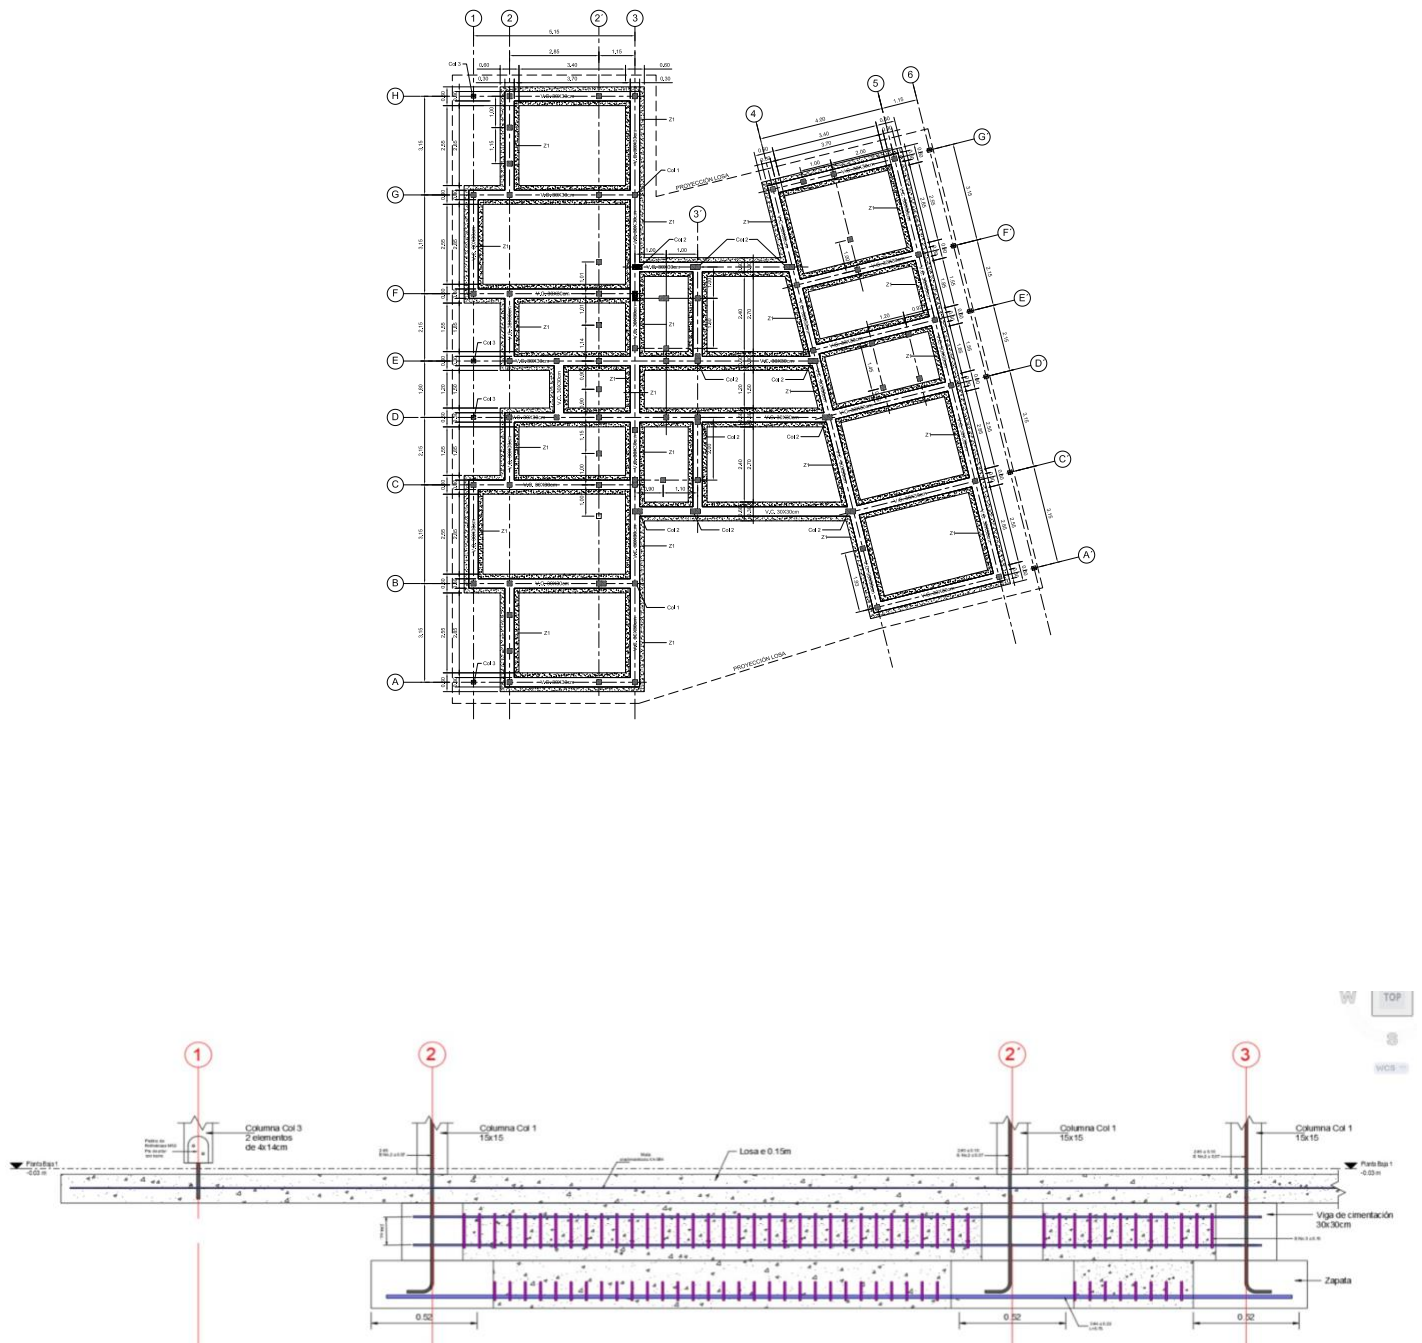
planta de cimentación y esquema general de zapata y viga de amarre
